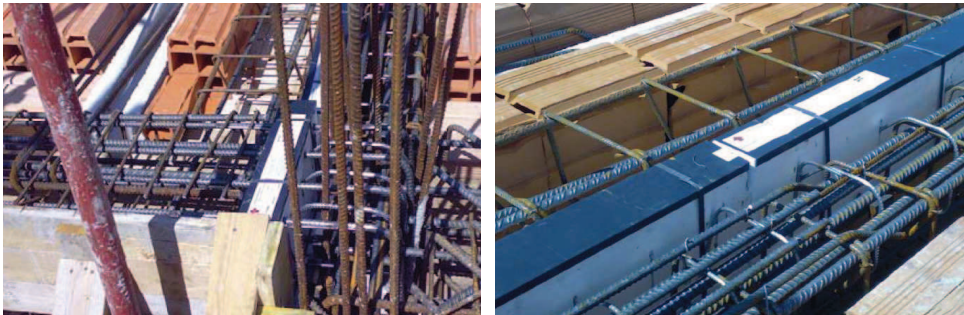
e 6.11 _Elementi a taglio termico strutturale: cantierizzazione.
